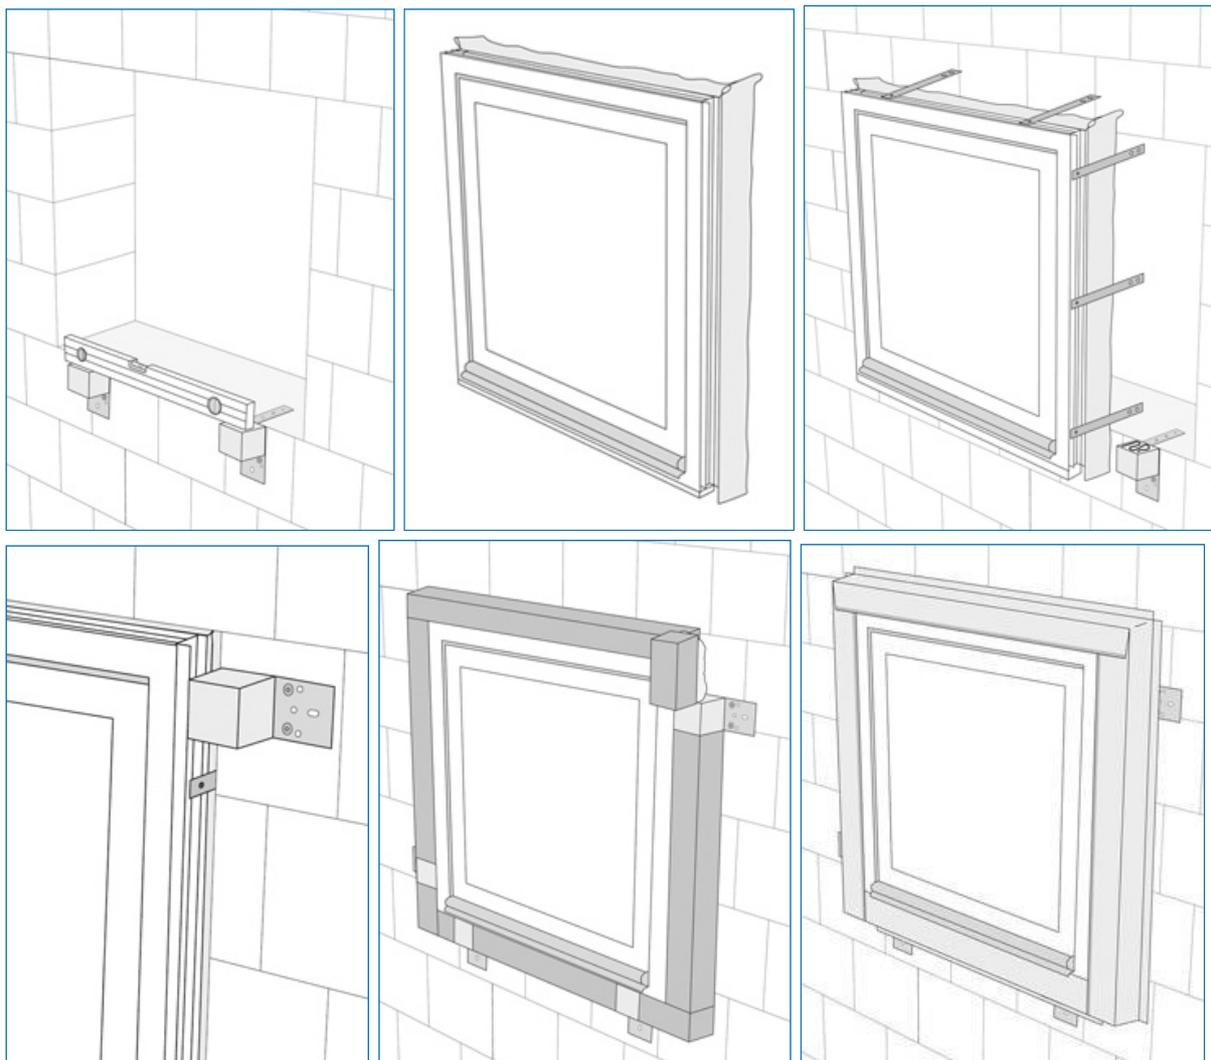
Phasen des Fenstereinbaus in der Wärmedämmschicht
